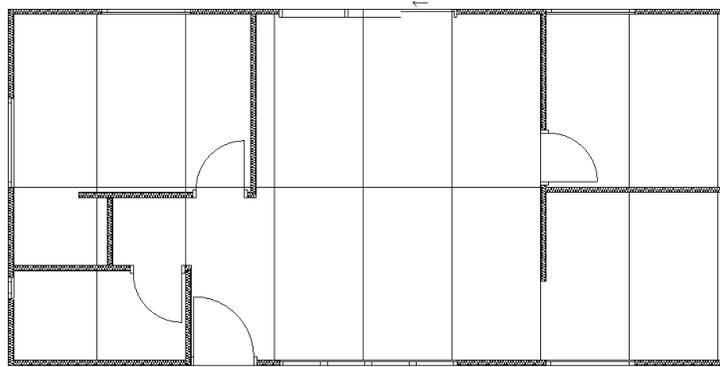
Esquema disposición paneles en planta de piso. Fuente: Elaboración propia.
